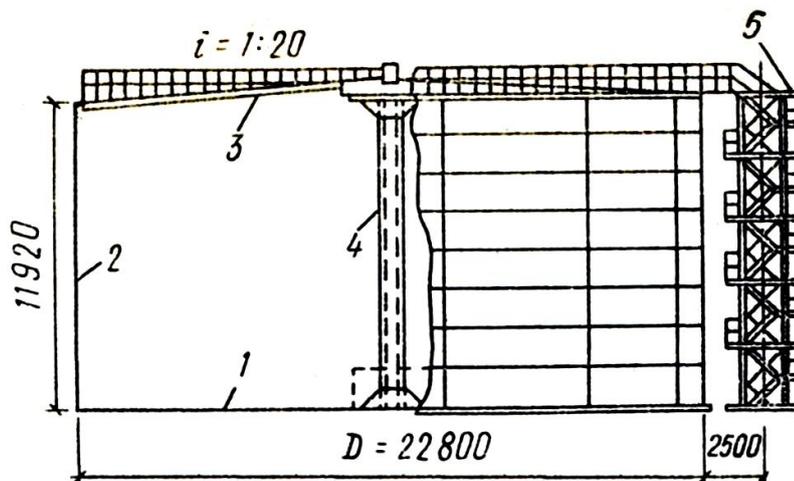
Вертикальный резервуар для хранения нефтепродуктов
